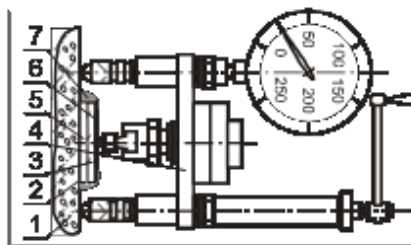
Схема випробування бетону приладом типу ГПНВ-5:
